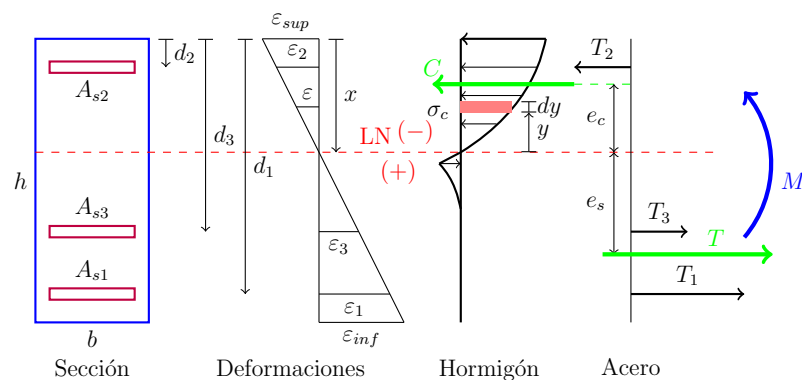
Comportamiento esquemático de una sección de hormigón armado.
